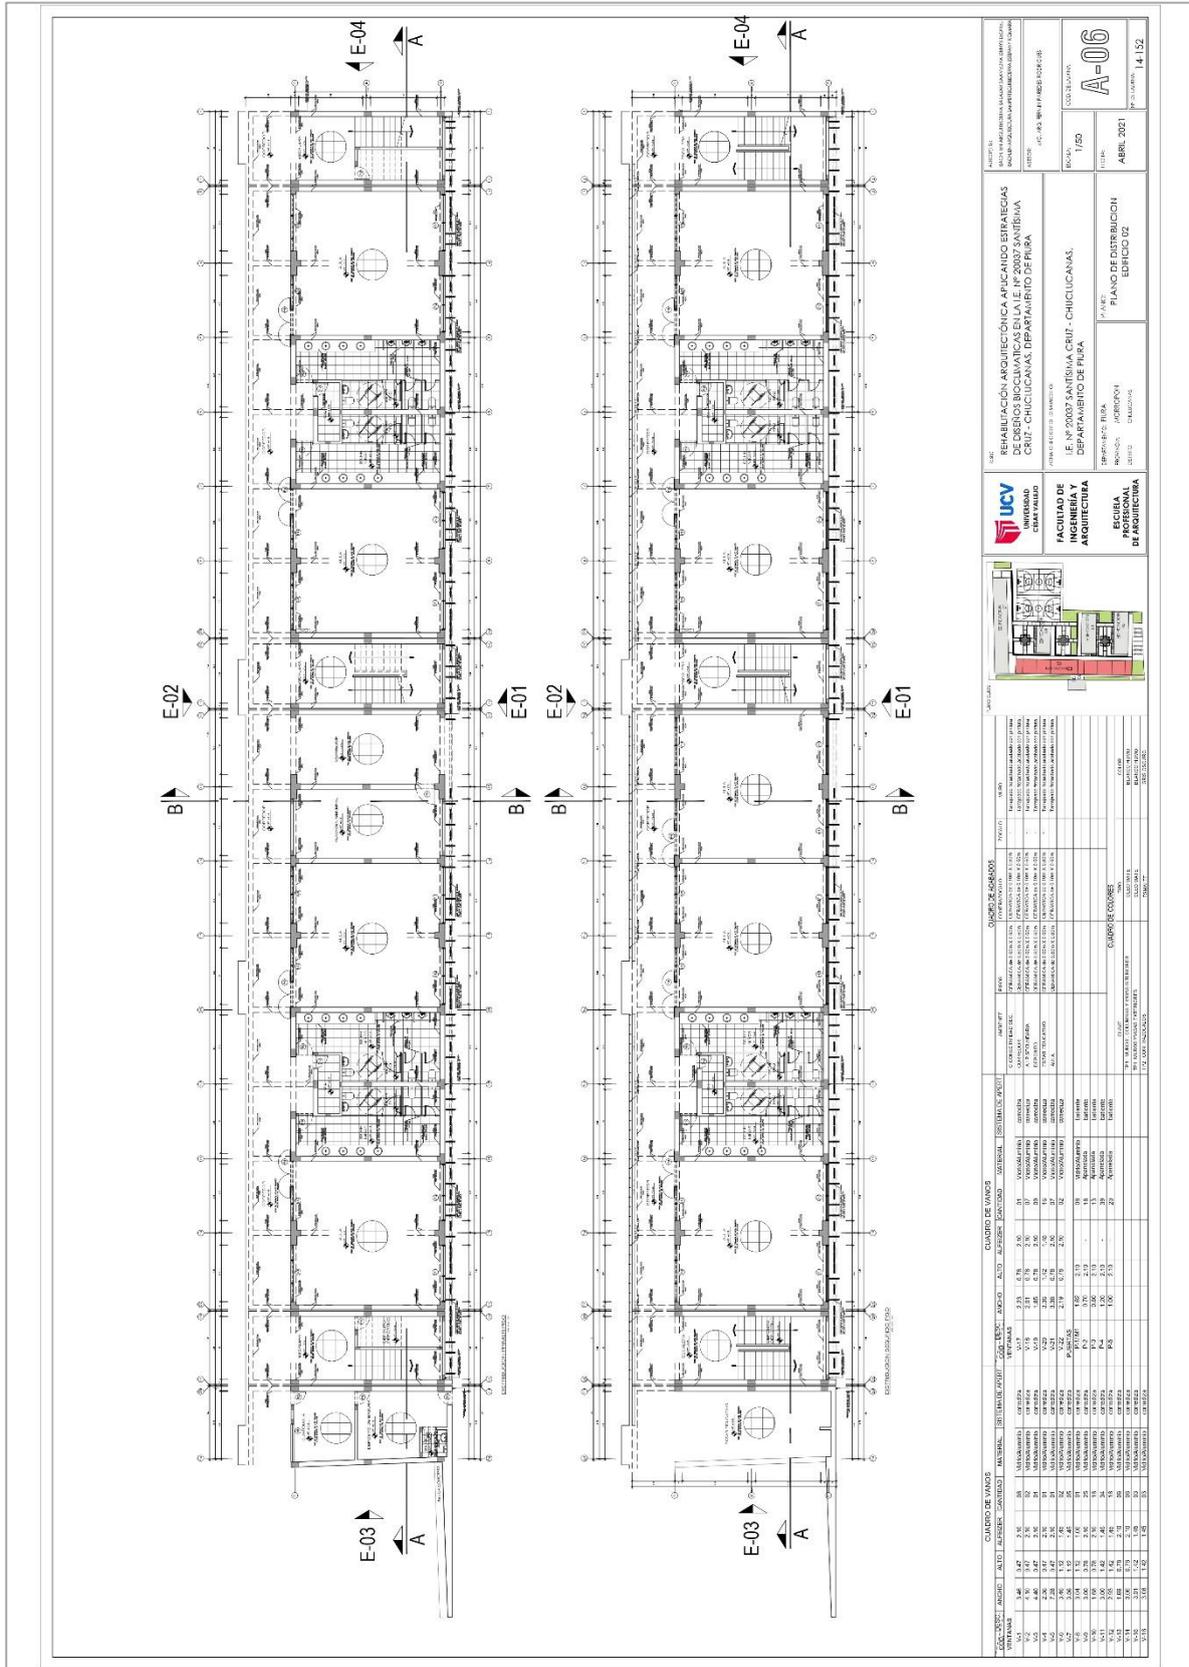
Lámina PG – 06: Planta General – Cortes y Elevaciones
